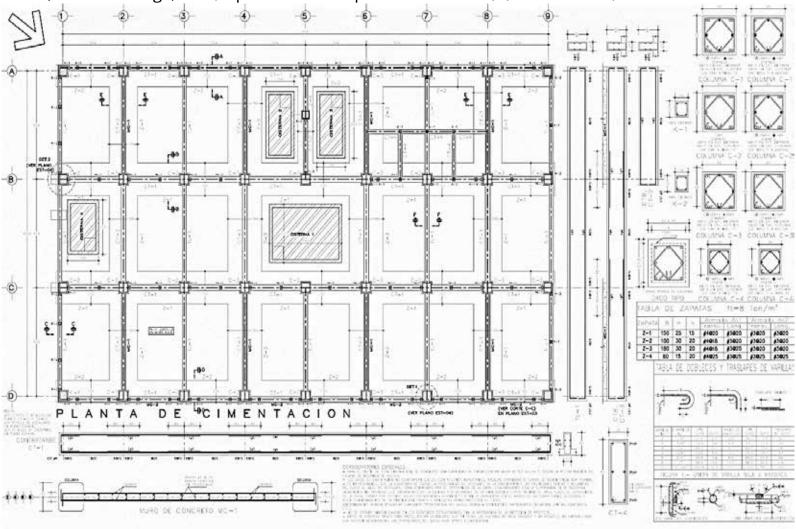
Planta de cimentación (Dependiendo del tipo de cimentación)
